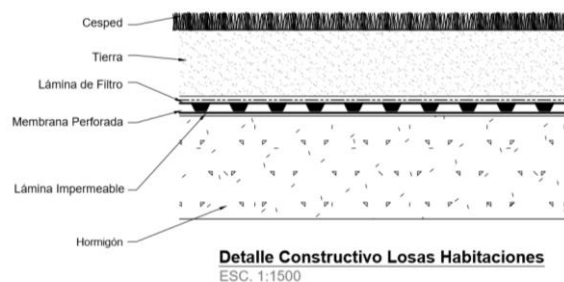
Detalle Constructivo de Losas en la Residencia de Artistas en San Juan.
